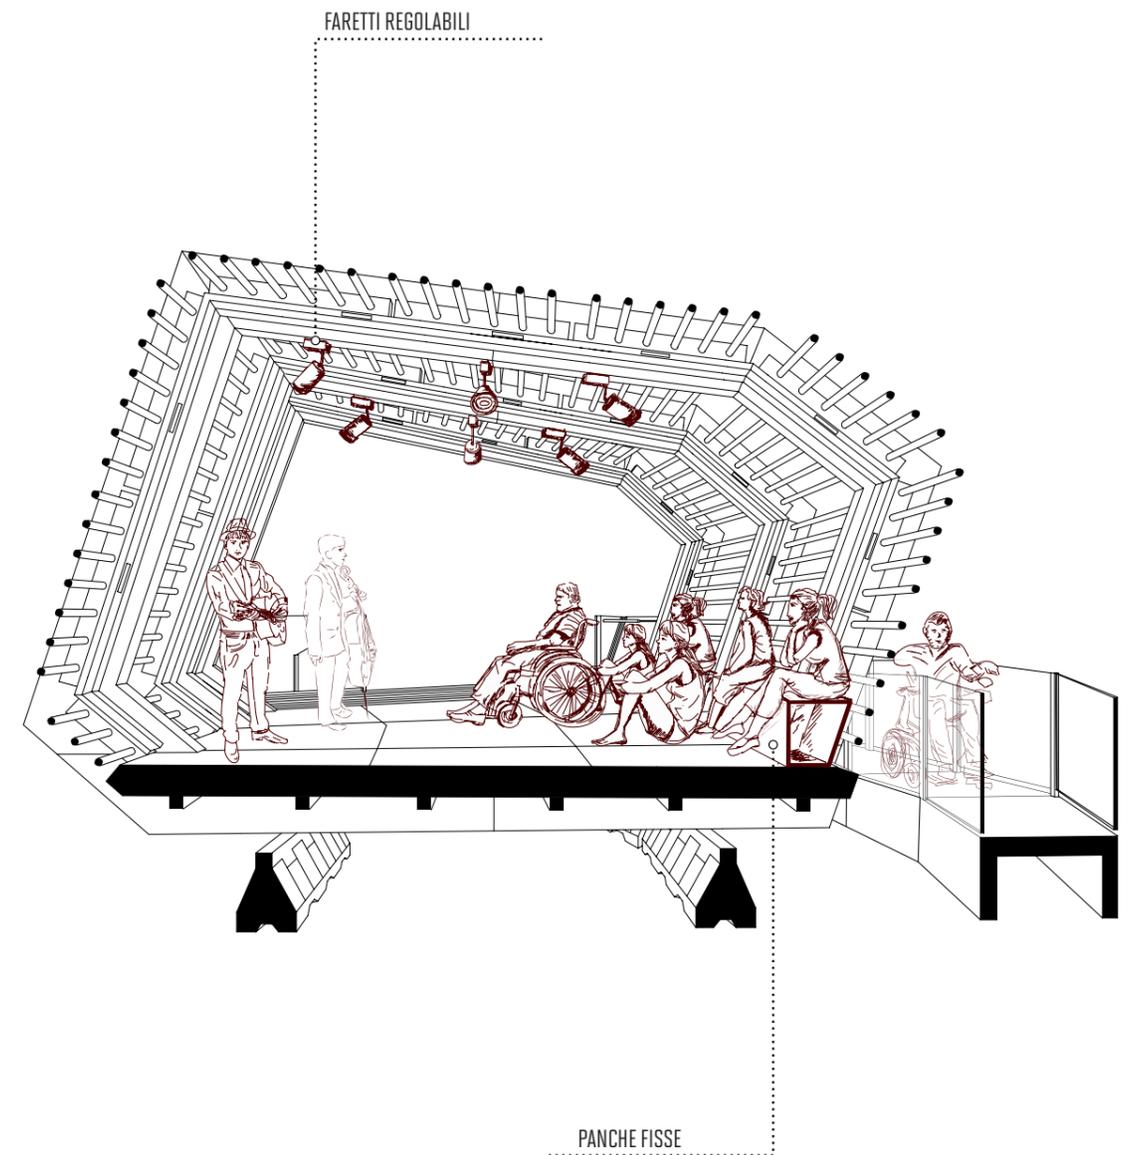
SEZIONE PROSPETTICA DEL BOX
